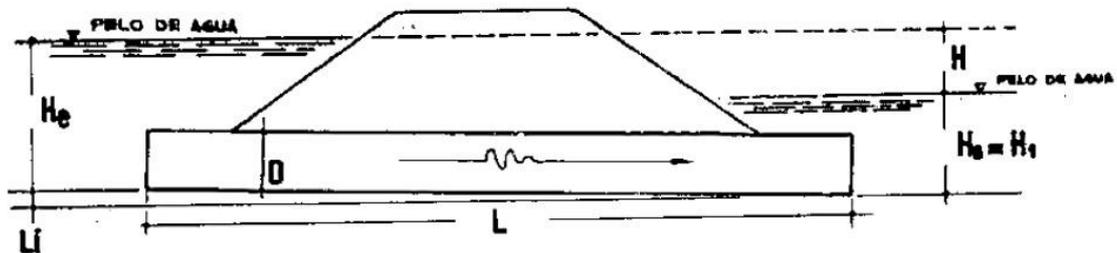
Alcantarilla tipo. Fuente: propia.
